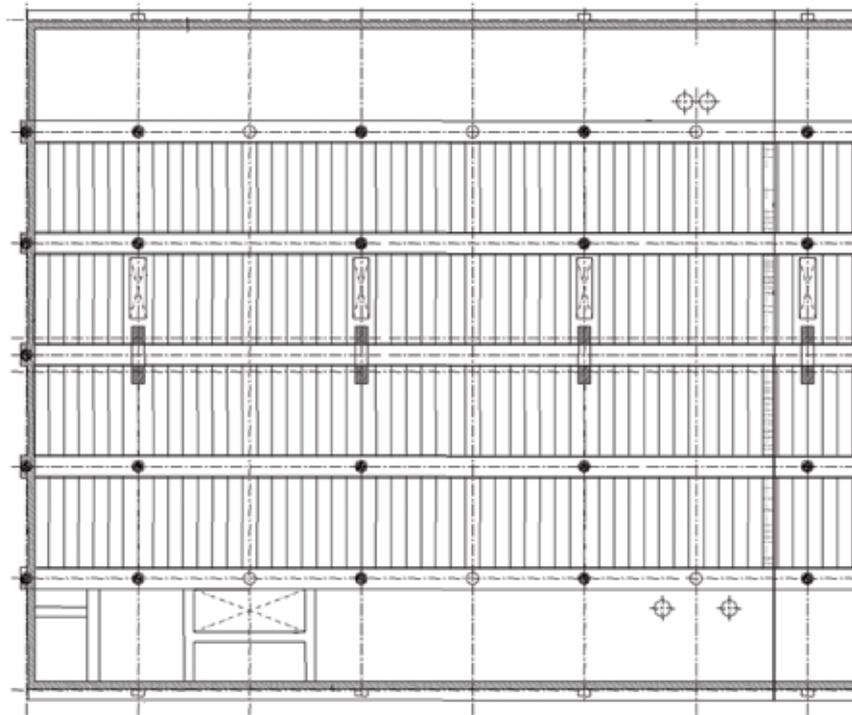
Abordagem geral da estrutura, pilares, vigas e placas.
